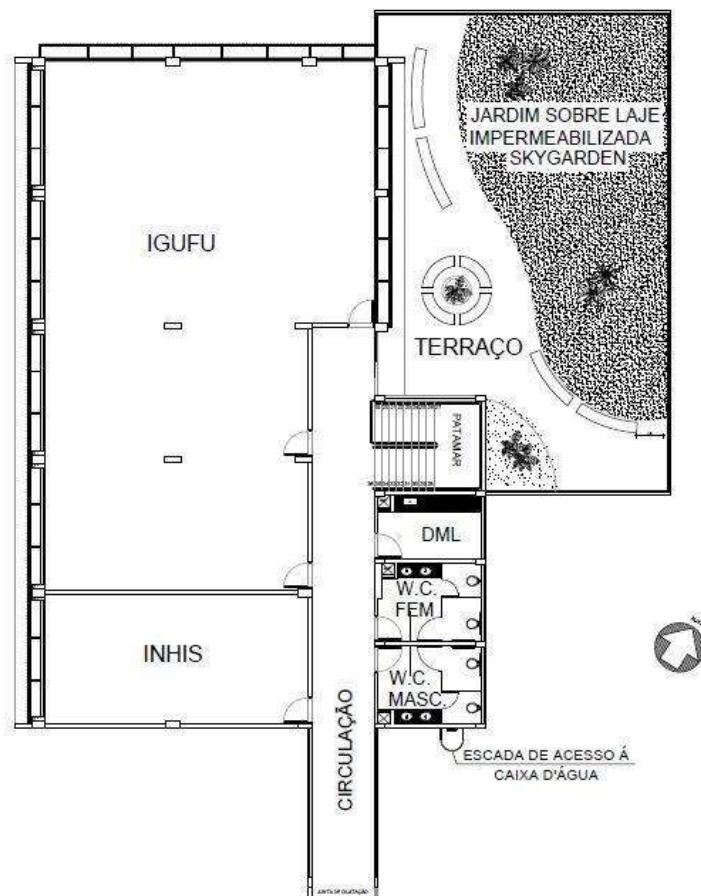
Etapa 02 - Planta Baixa do Térreo e Primeiro Pavimento
